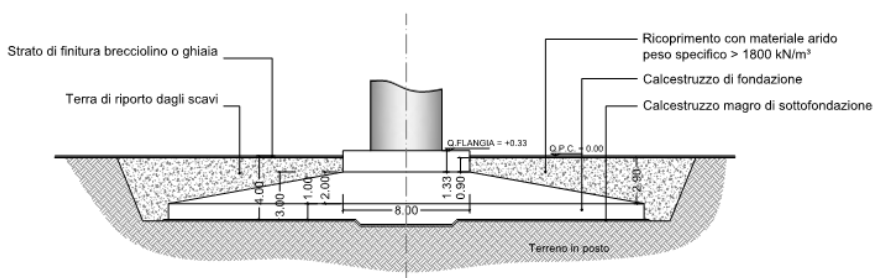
Pianta e vista della fondazione tipo dell'aerogeneratore
